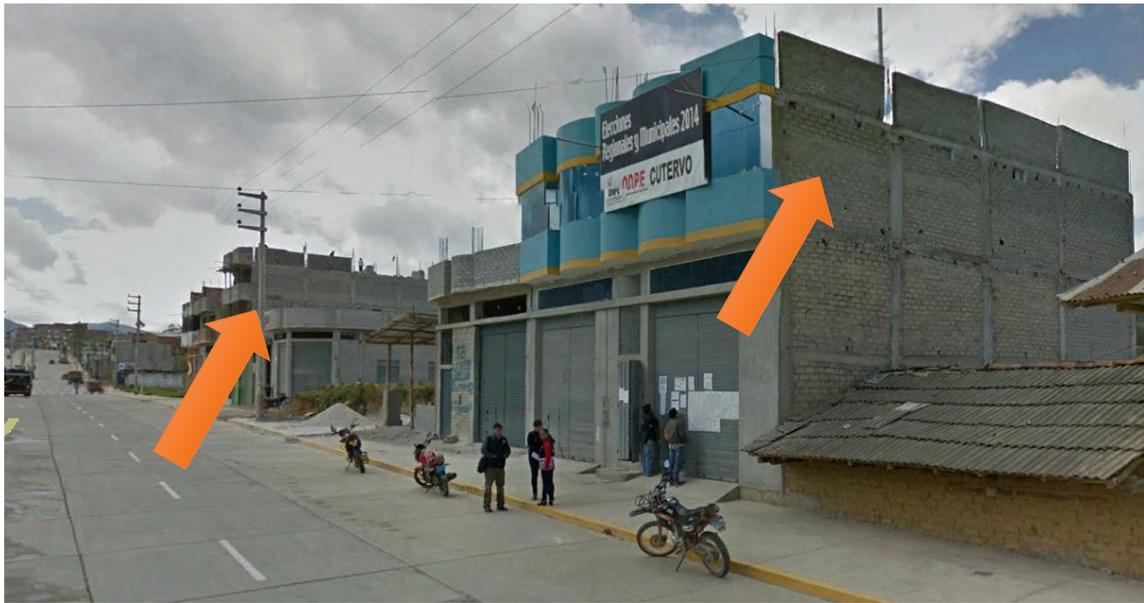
Vista de la utilización de ladrillo de concreto en avenida Salomón Vilches Murga
